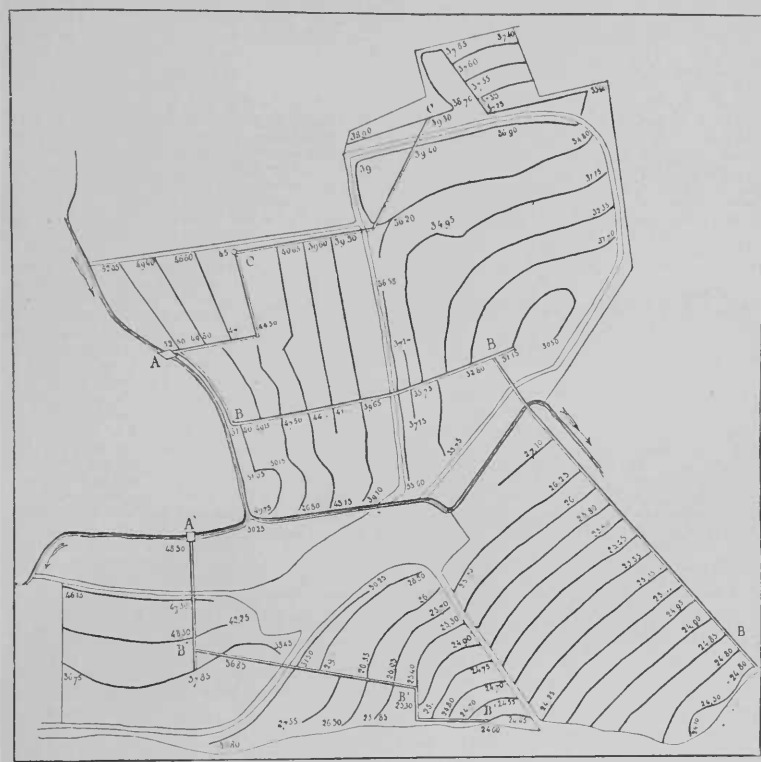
Plan d'une irrigation par rigoles inclinées.
